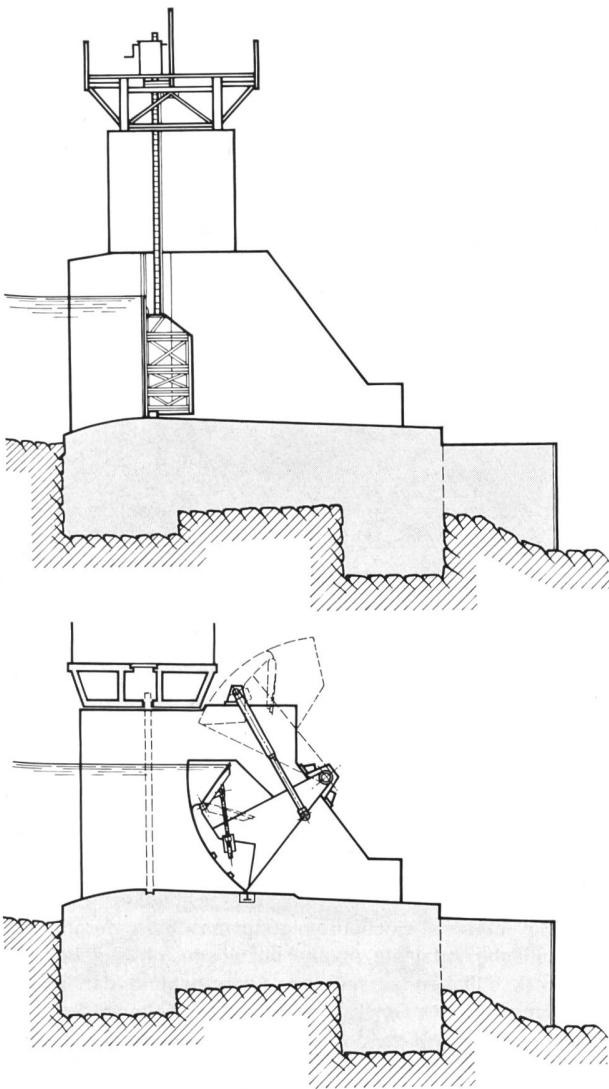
Lageplan des alten (oben) und des neuen Einlaufes zum Oberwasserkanal.
